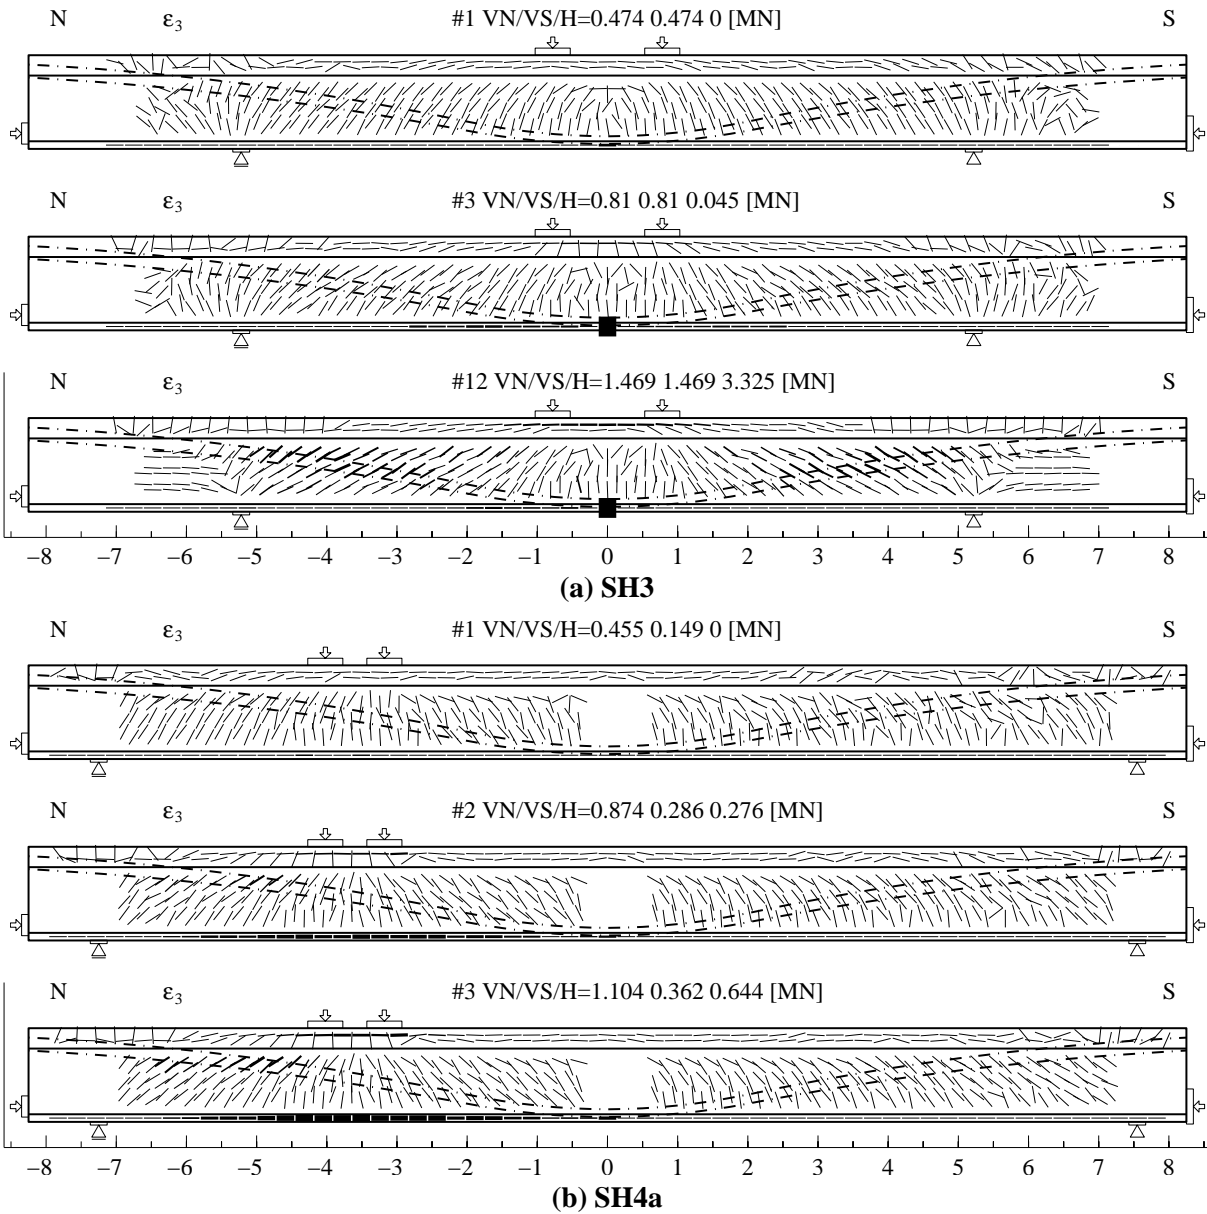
Essais SH3 et SH4a : orientation et intensité de la déformation principale ϵ_3 (aile inférieure : ϵ_x) du béton pour le premier palier, le palier avec fissuration flexionnelle stabilisée et le dernier palier (longueur de mesure : 270 mm)
